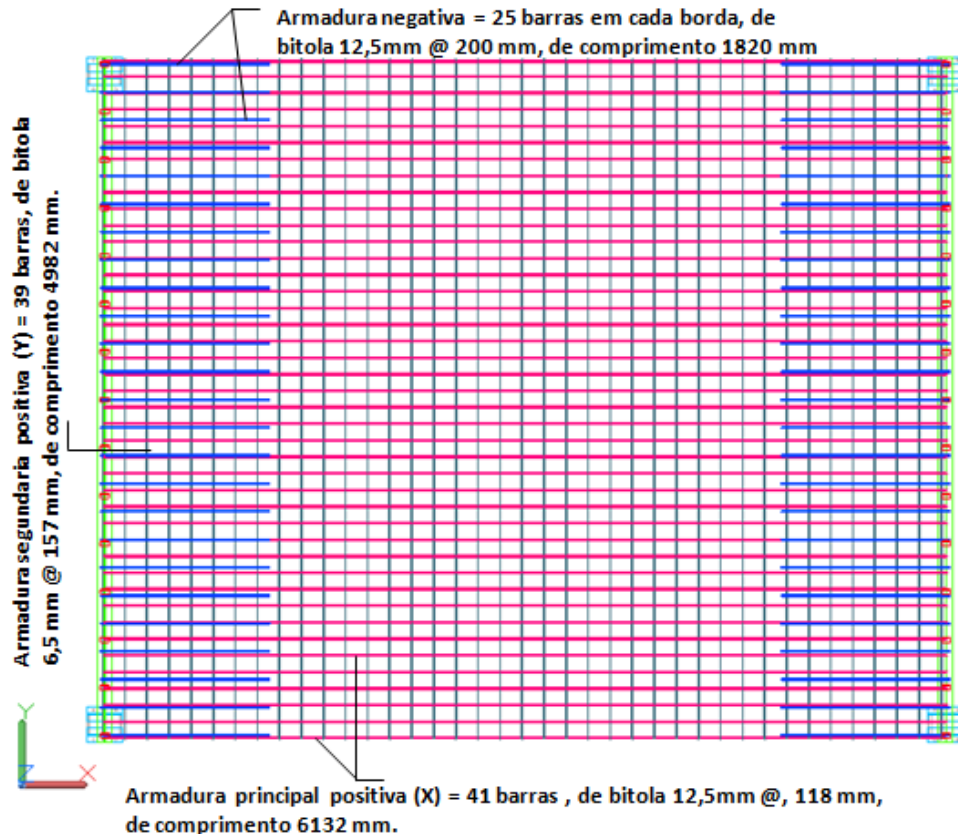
Vista em planta da plataforma de ensaios dinâmicos e detalhamento da armadura da laje de concreto.
